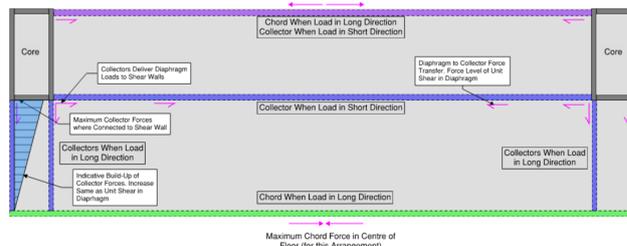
Planta estrutural de um piso exemplificativa de um diafragma simples
